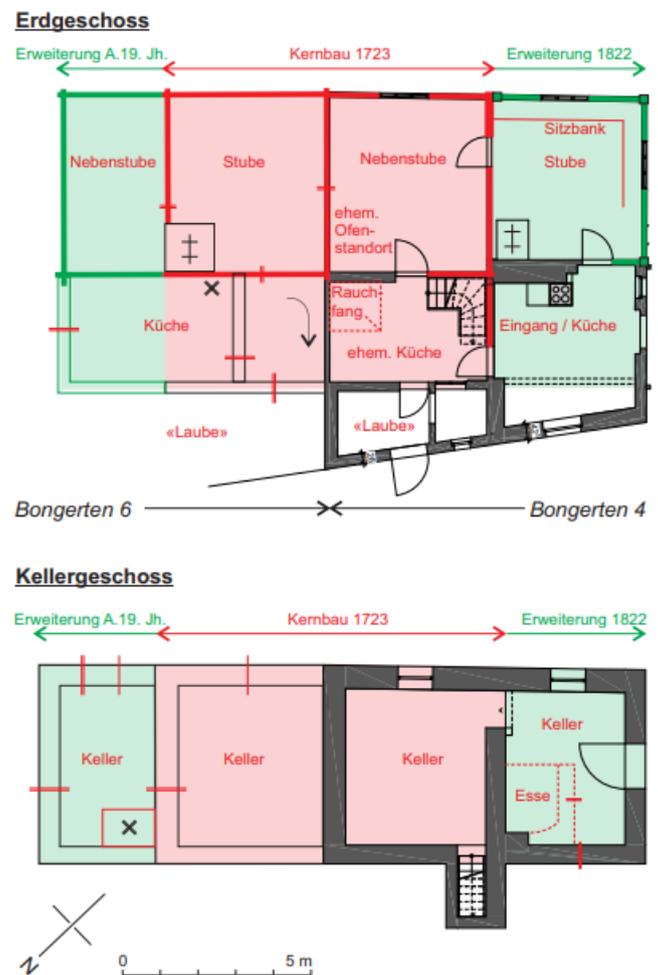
Grundrisse des Doppelwohnhauses, 1:200.
